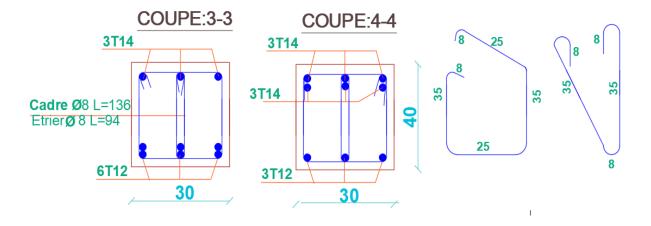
Ferraillage de la poutre secondaire ( $30 \times 40$ ).
